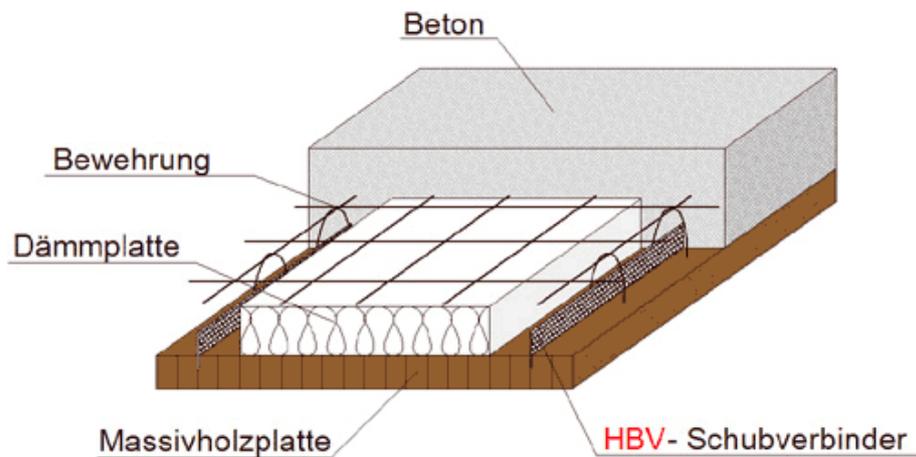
Dreidimensionale Darstellung einer Hohlkastendecke¹⁴³
